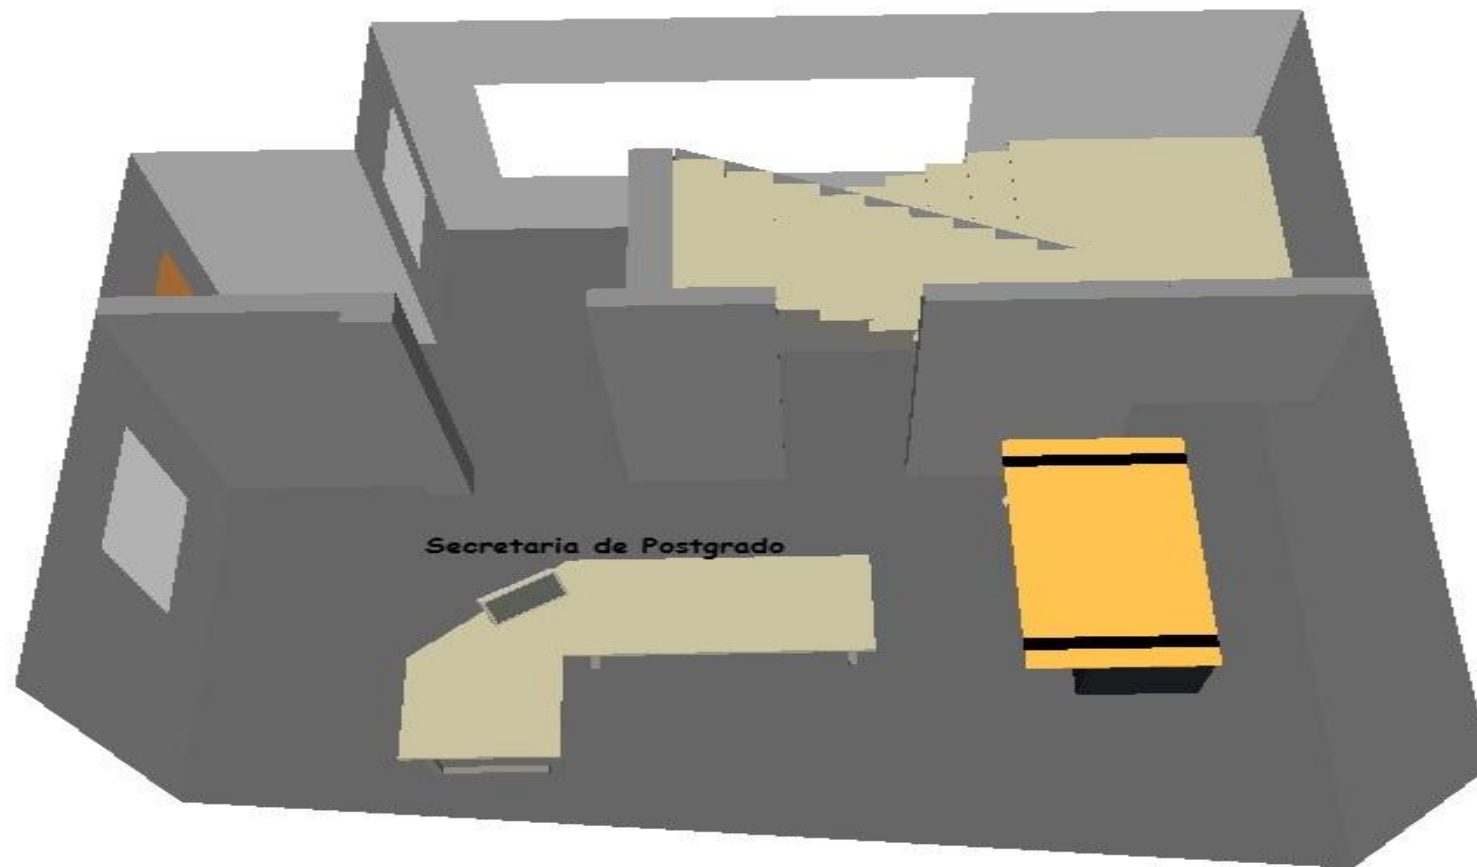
Plano tipo X Distribución de las oficinas planta baja B
